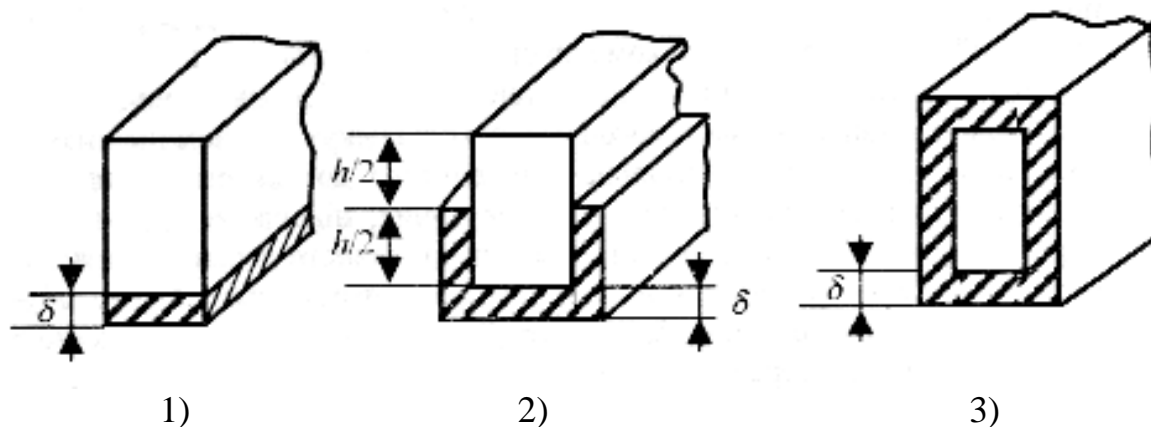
Схема підсилення залізобетонних балок: 1 – нижня розтягнута грань балки; 2 – розтягнута зона до осьової лінії; 3 – у вигляді обойми.
